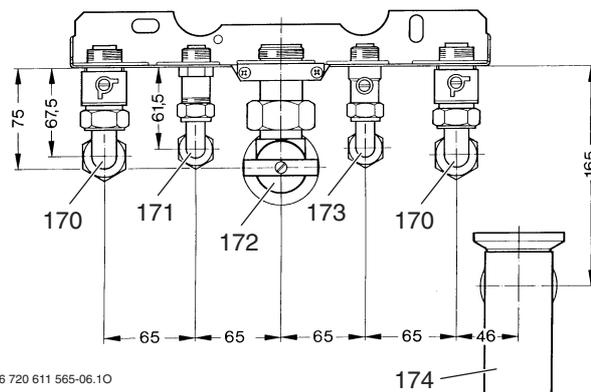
Piastra di allacciamento e montaggio con installazione sotto intonaco (installata)
